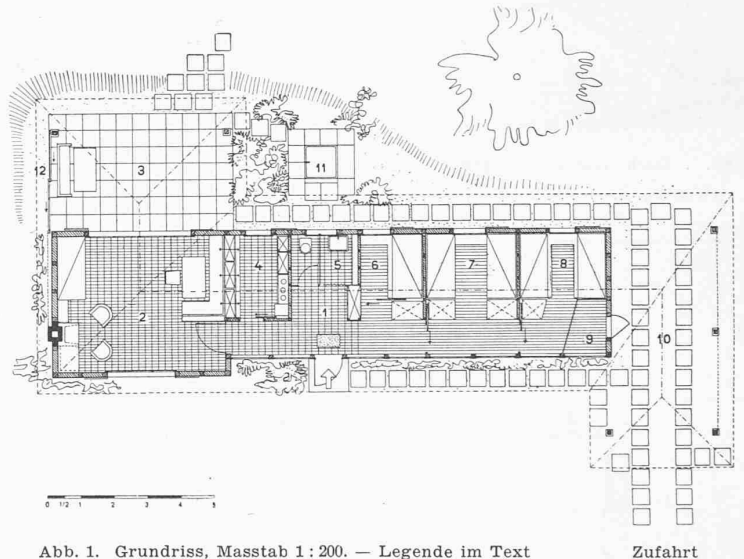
Grundriss, Masstab 1 : 200. — Legende im Text
